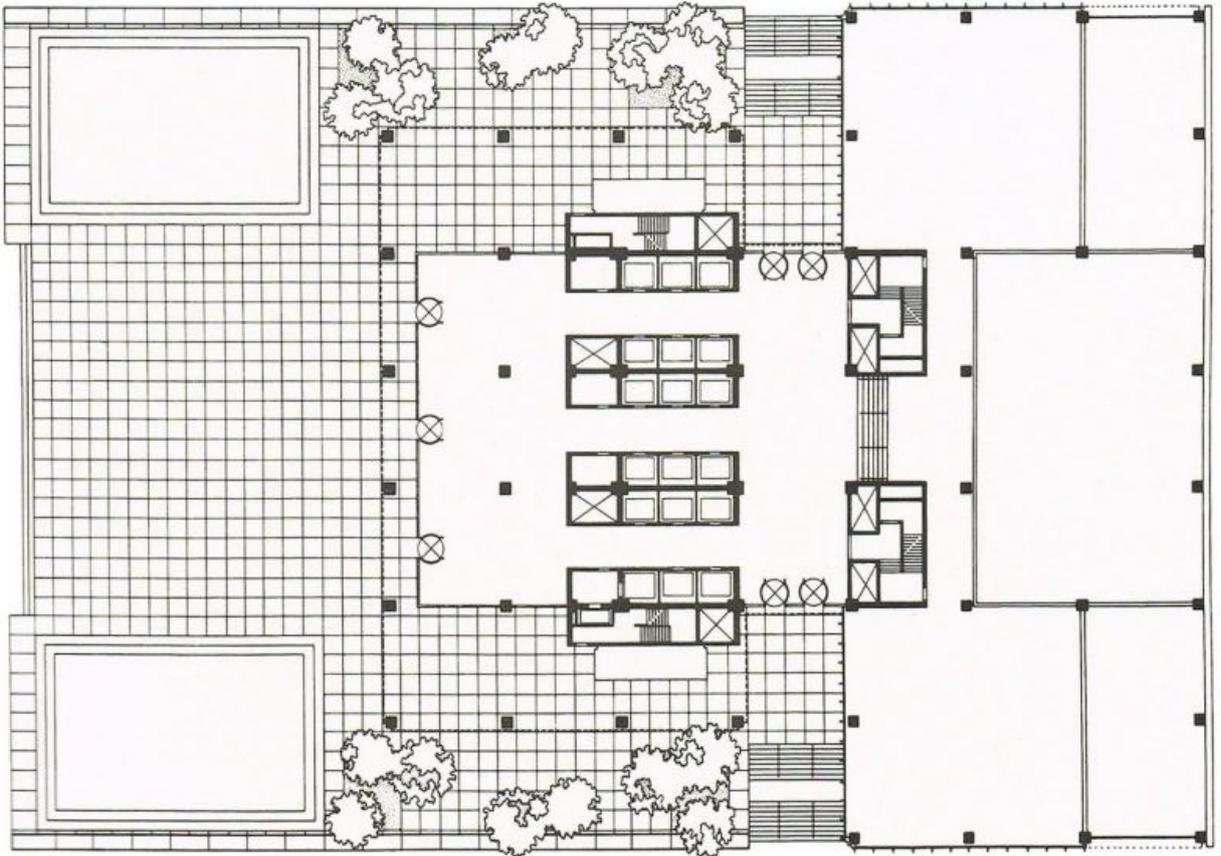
Grundriss Erdgeschoss Seagram Building
